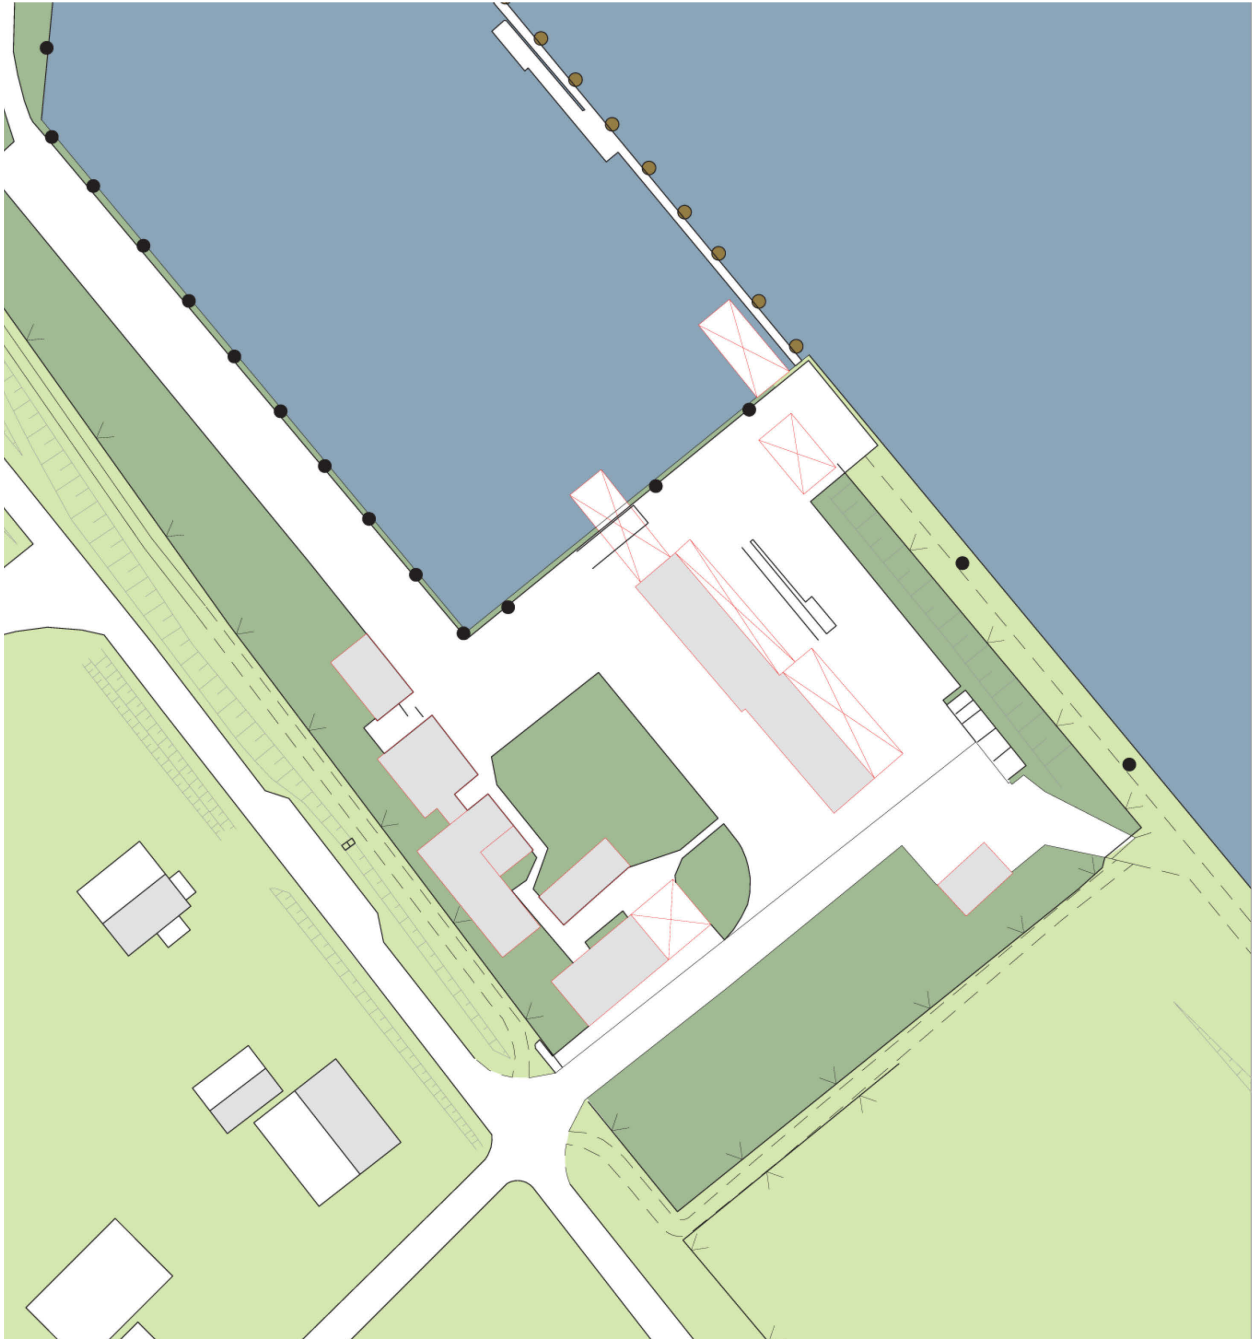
Lageplan für das Grundstück mit aktueller Bebauung
